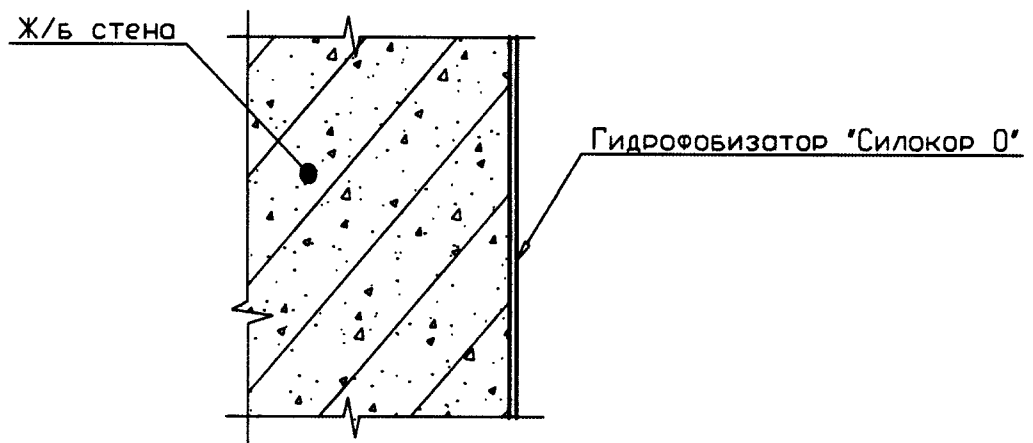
Обработка поверхностей конструкций гидрофобизатором «Силокор». Обработка поверхностей железобетонных стен
